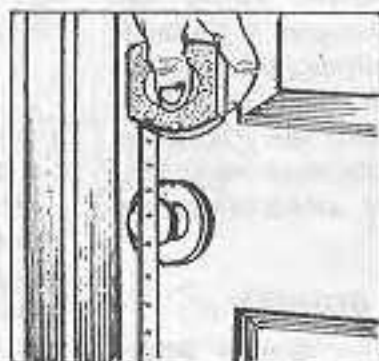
Замер внутренних размеров дверной коробки и высоты расположения ручки
